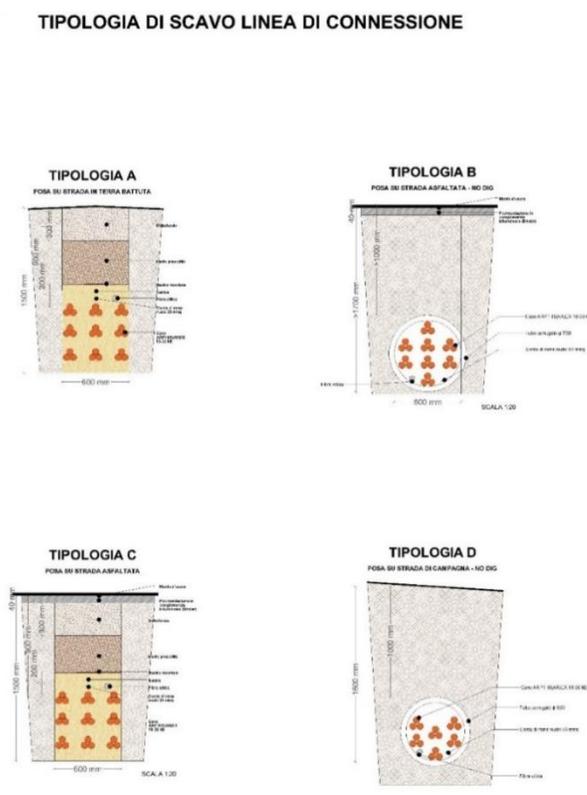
Particolare sezione tipo cavo interrato MT e particolari della sezione stradale
